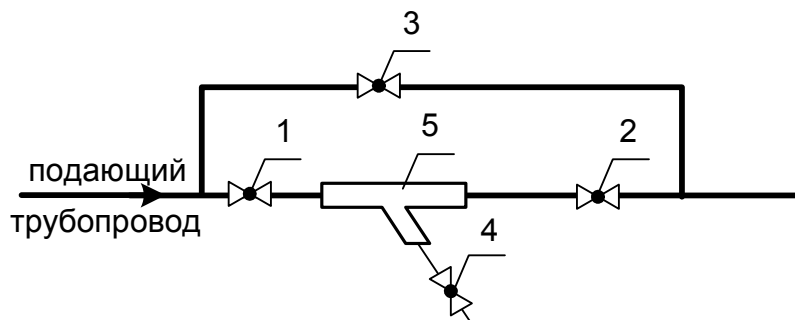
Схема для очистки фильтра теплоносителя из подающего трубопровода через байпасную линию
